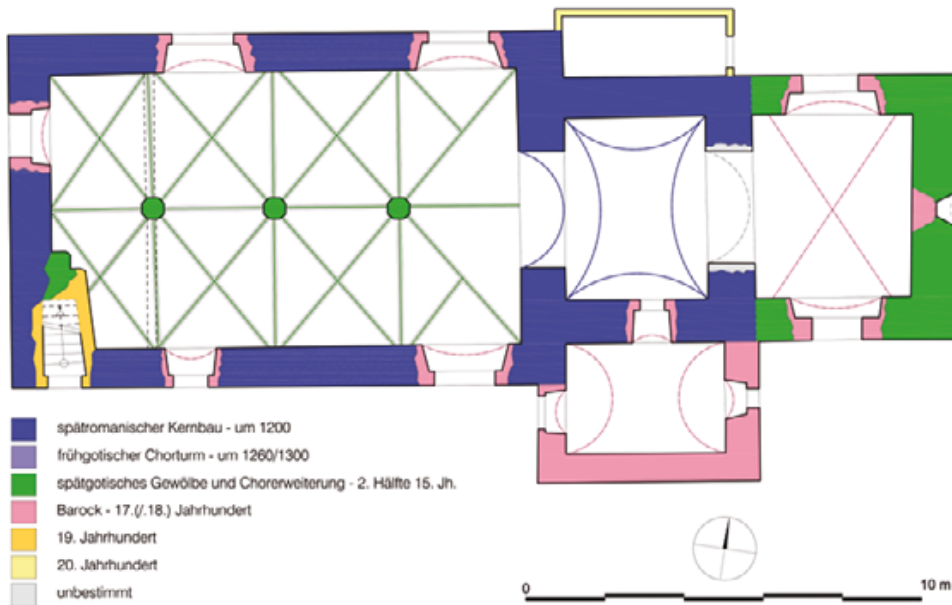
Sallingstadt, Pfarrkirche hl. Martin. Baualterplan.
